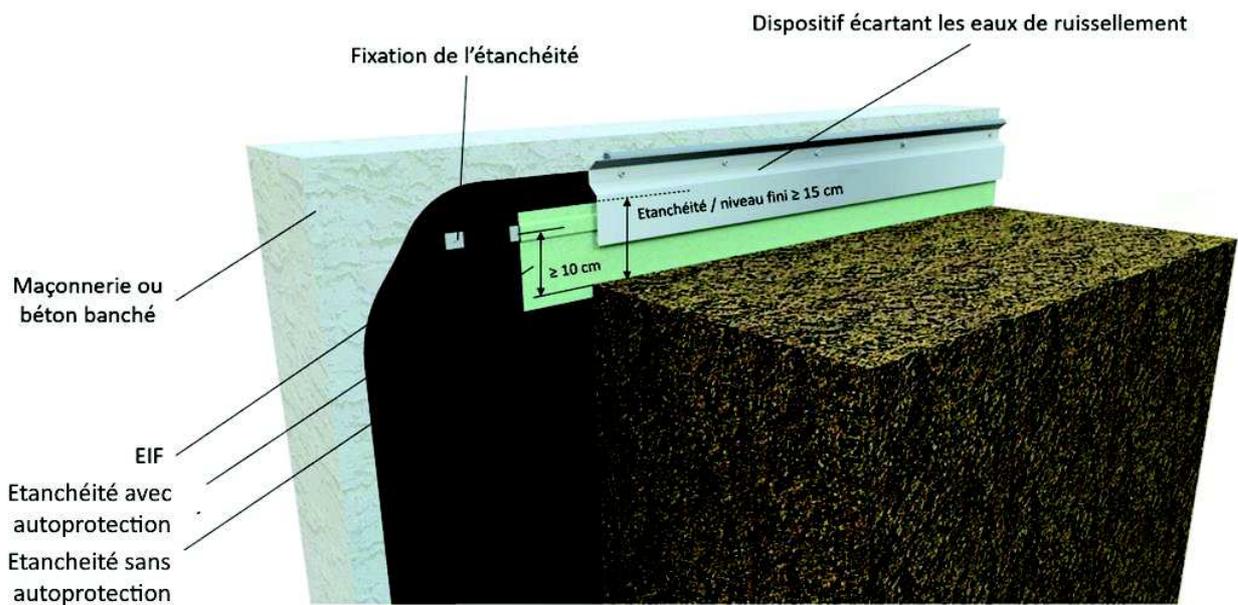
Protection en tête par solin métallique - exemple avec étanchéité sans autoprotection
